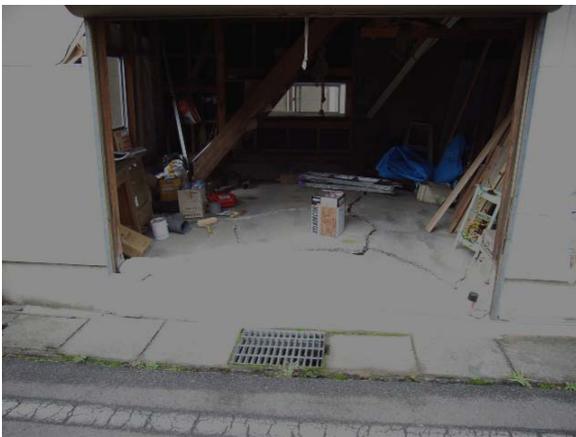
写真 5.6 の土間コンのひび割れ
